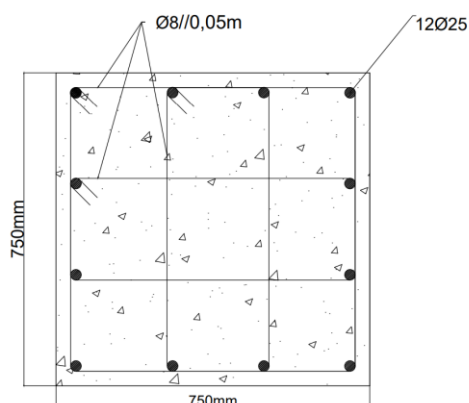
Secção transversal do pilar 1 na ligação do rés-do-chão ao piso 1
